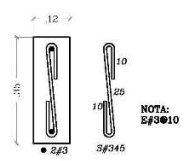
Planos Estructurales - Planta de cimentación. Fuente: INDERVALLE.
